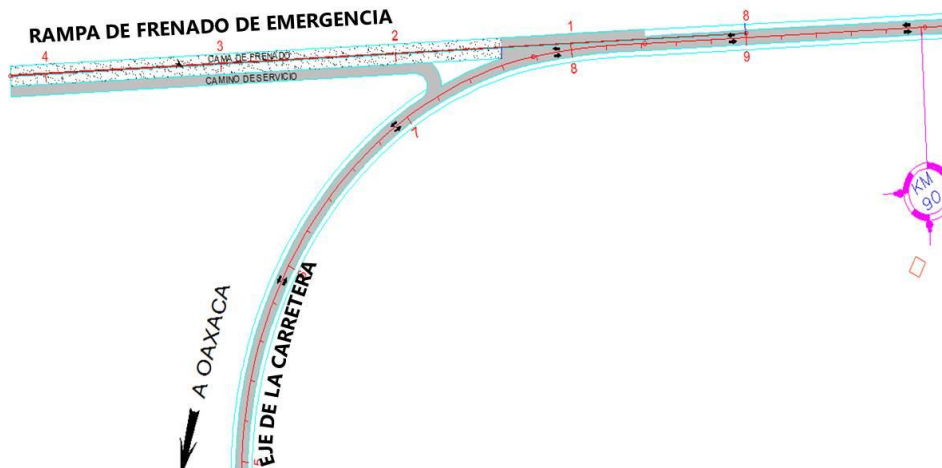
Rampa de frenado de emergencia. Sección en planta
